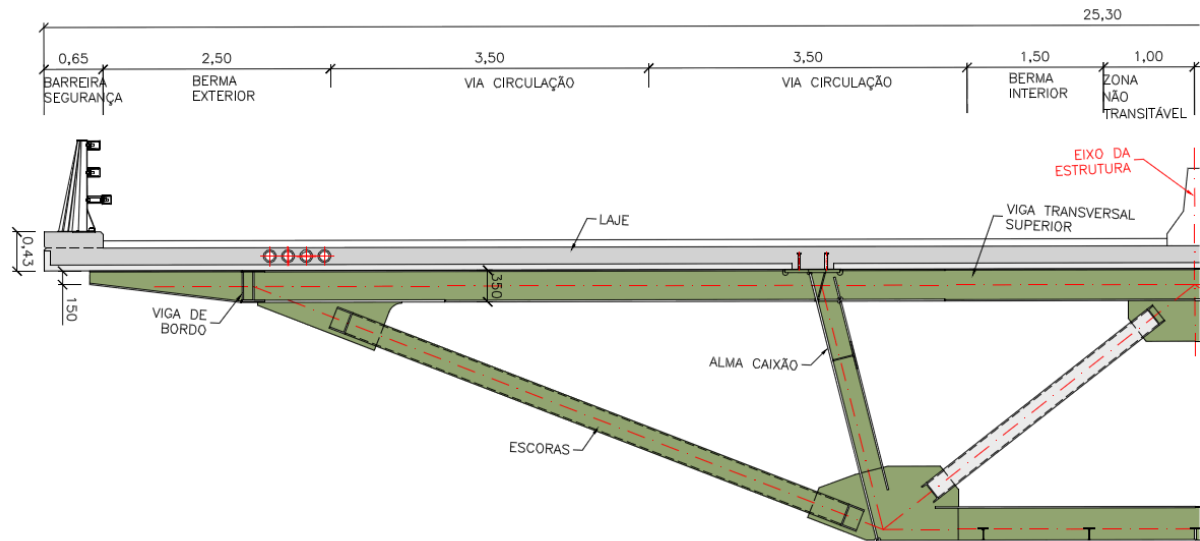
Secção transversal em caixão com travessa superior escorada
